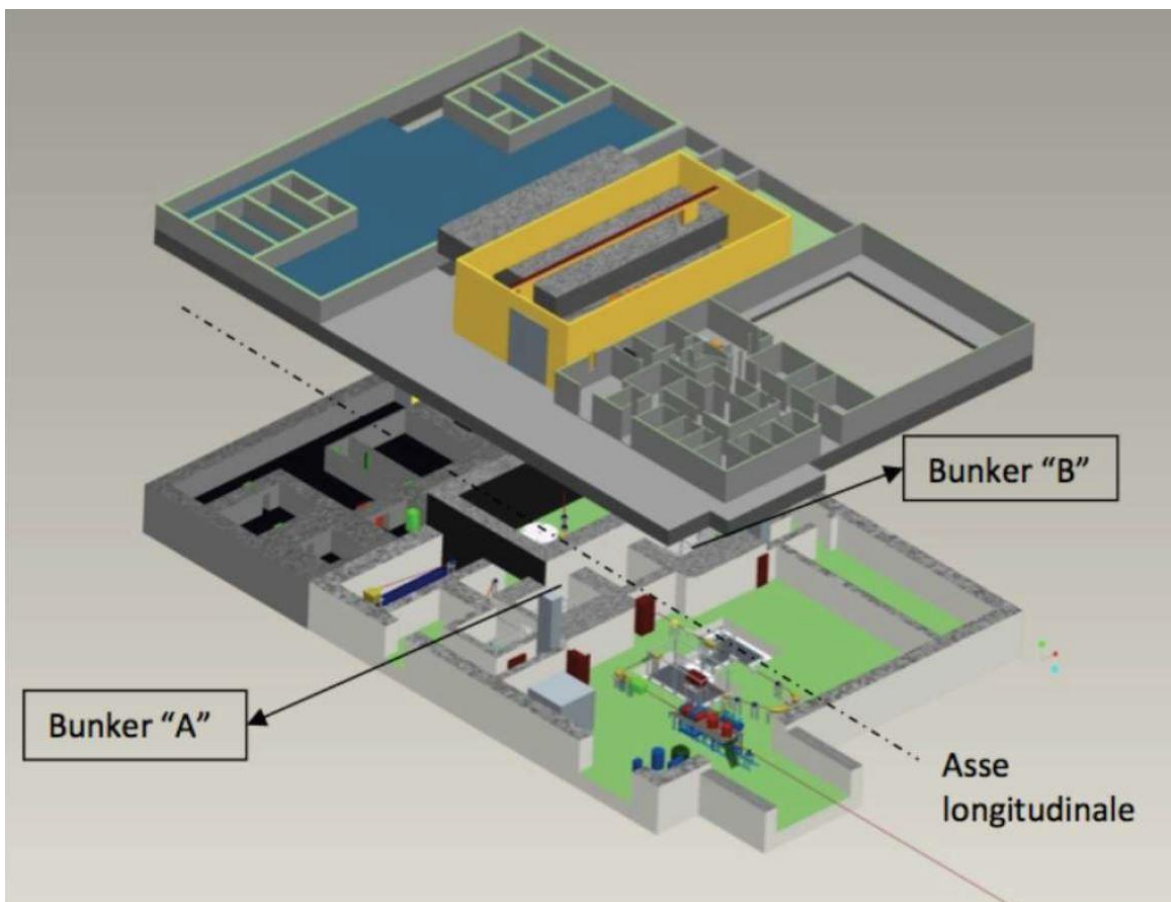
Planimetria tridimensionale dell'edificio SPES.
